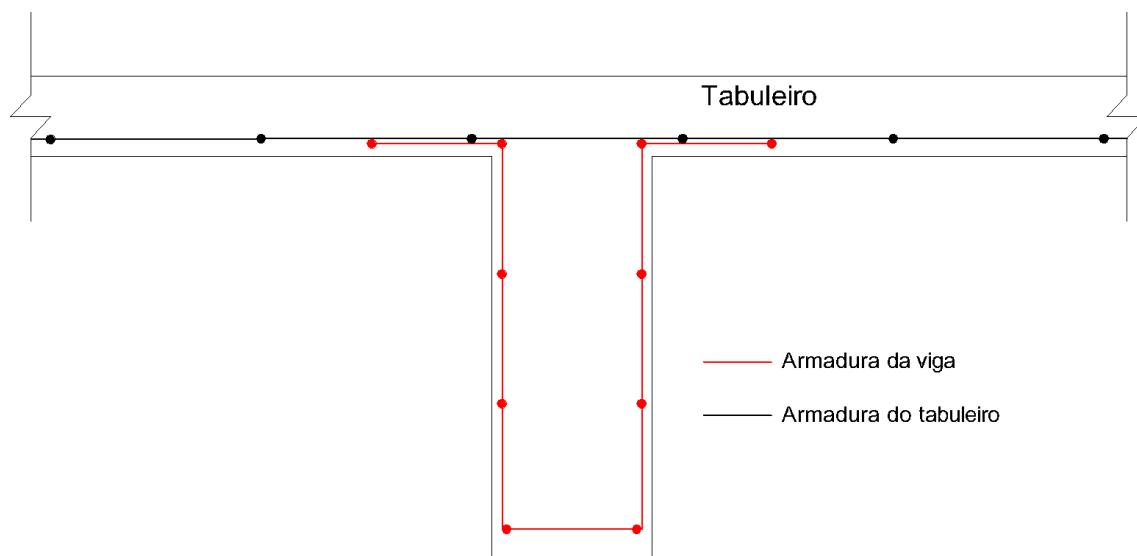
Croqui das armaduras – Seção transversal da longarina
